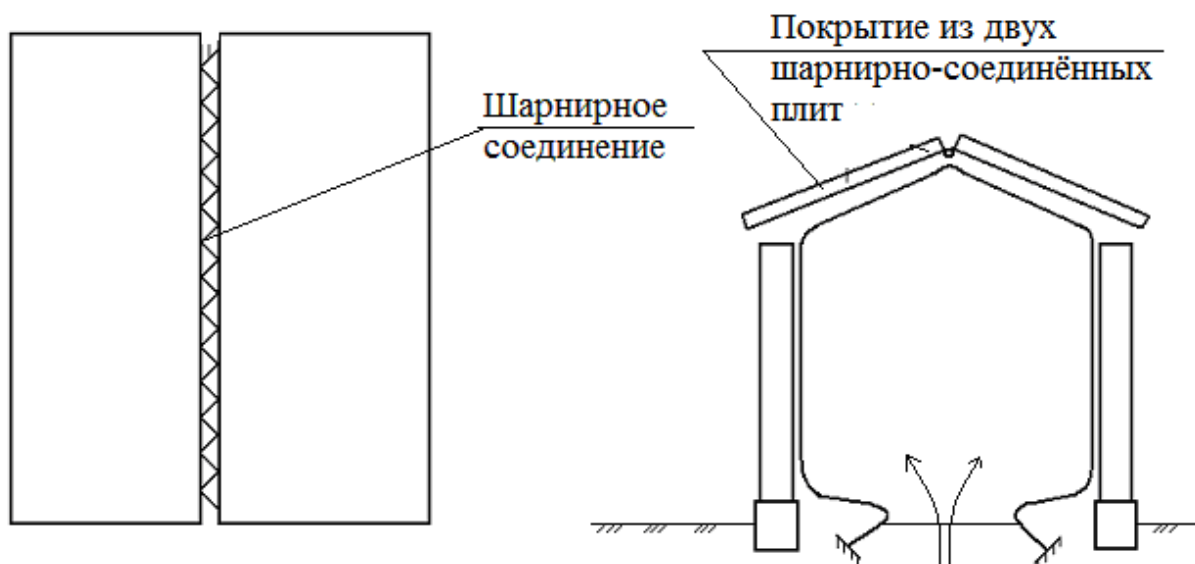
Бетонирование и подъём покрытия с применением пневматической опалубки
